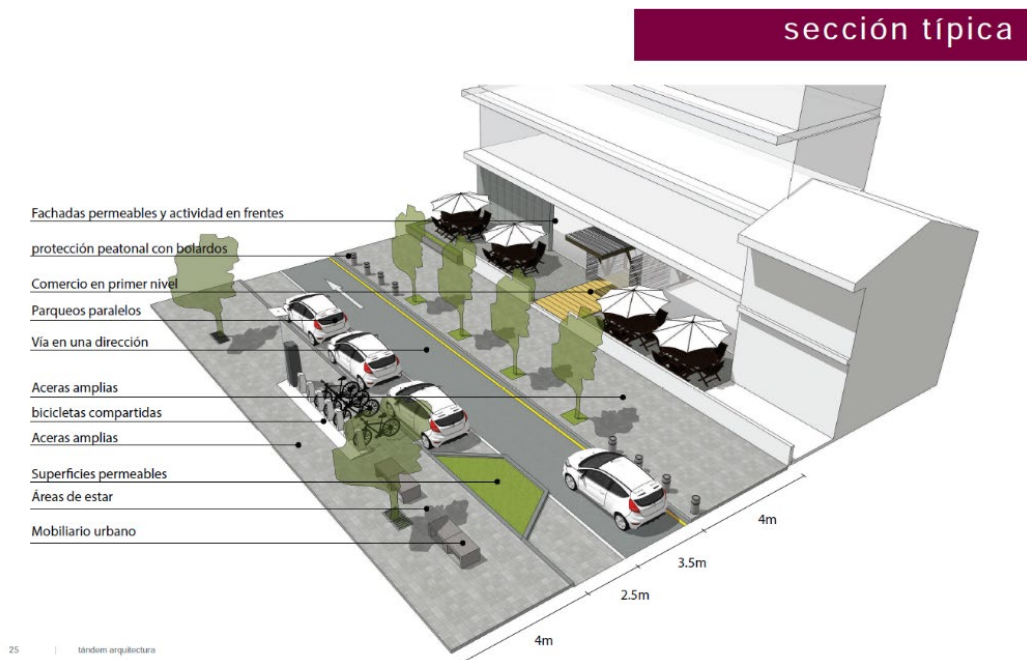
Sección Típica propuesta Plan Maestro Barrio Escalante (Tándem Arquitectura, 2017).
